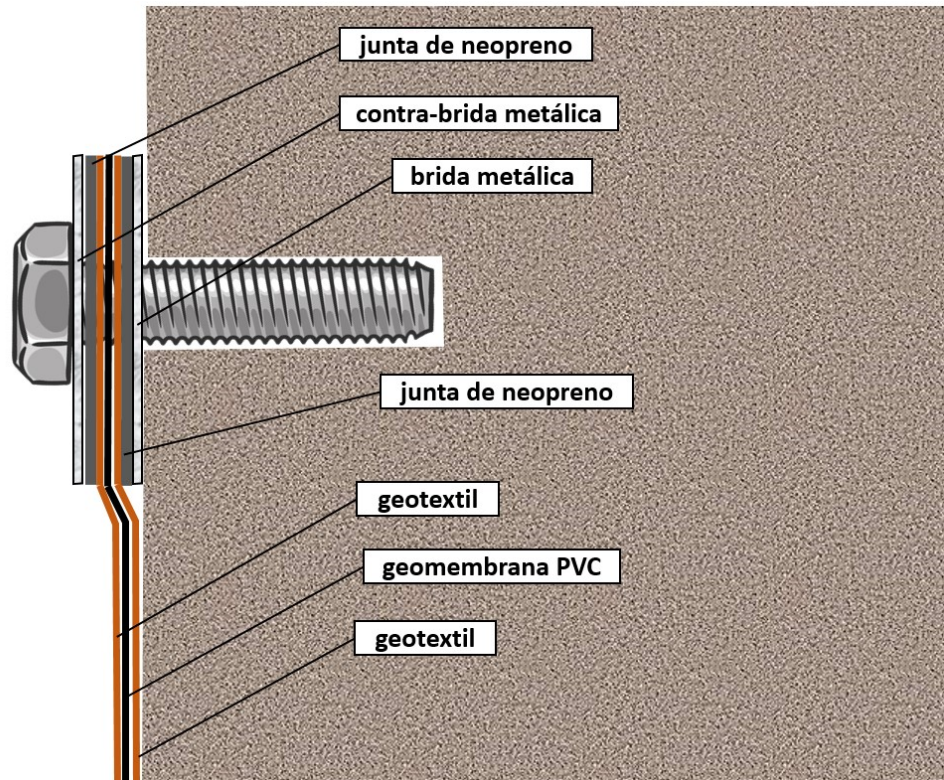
Detalle de la fijación de la geomembrana y los geotextiles al paramento de hormigón.
